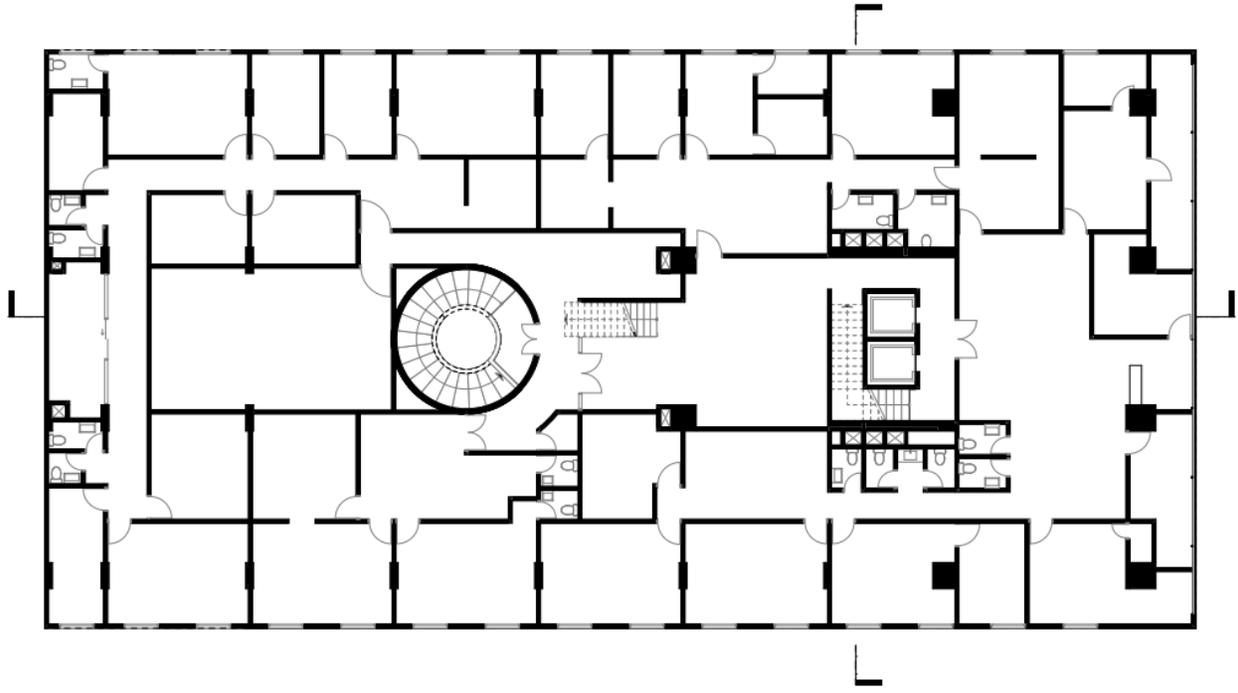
Planta alta actual N+6.50. Fuente: Tesistas.
